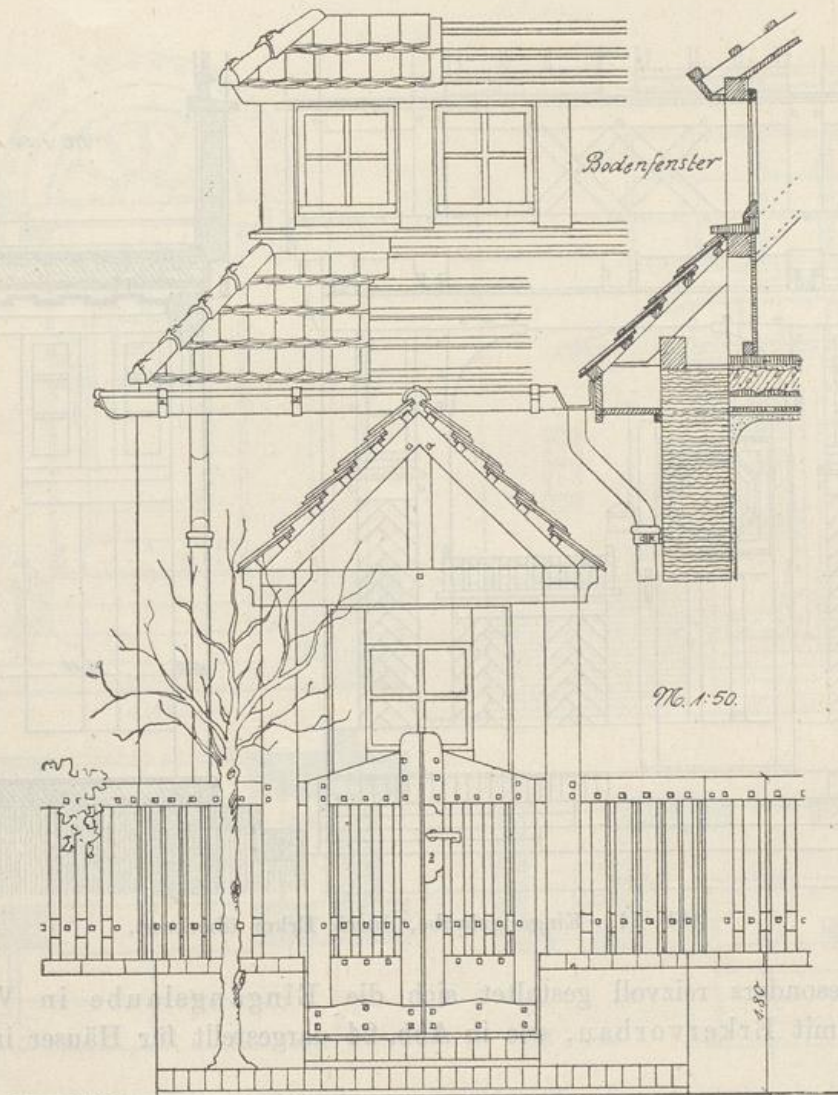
Hauseingang unter Laube. Vergl. Grundriß Abb. 20.
